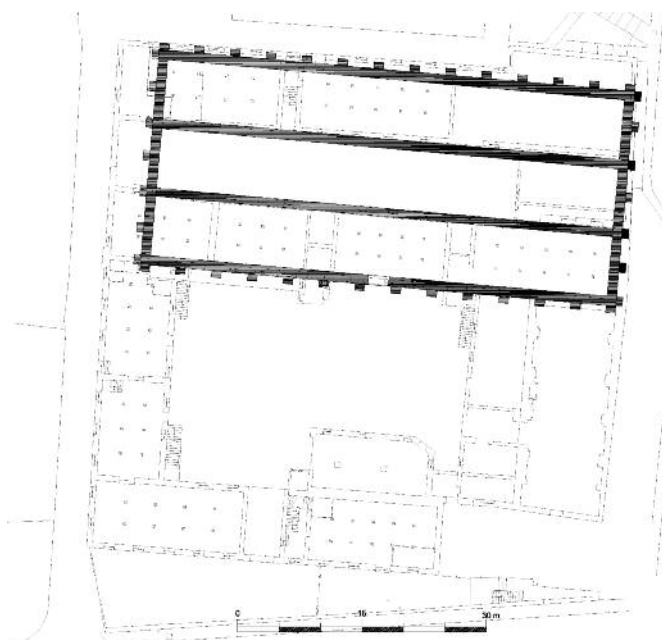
Reconstrucción de la planta de la Casa de Hernando Colón.
